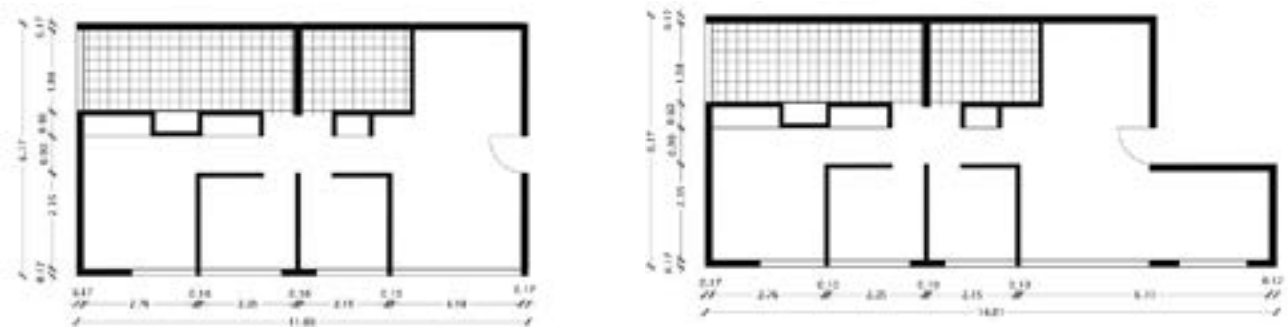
Tipologías de departamentos en el proyecto 1020. Planos de arquitectura con dimensiones.
